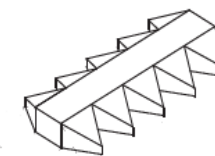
Фундамент с ломаным очертанием краевой зоны
